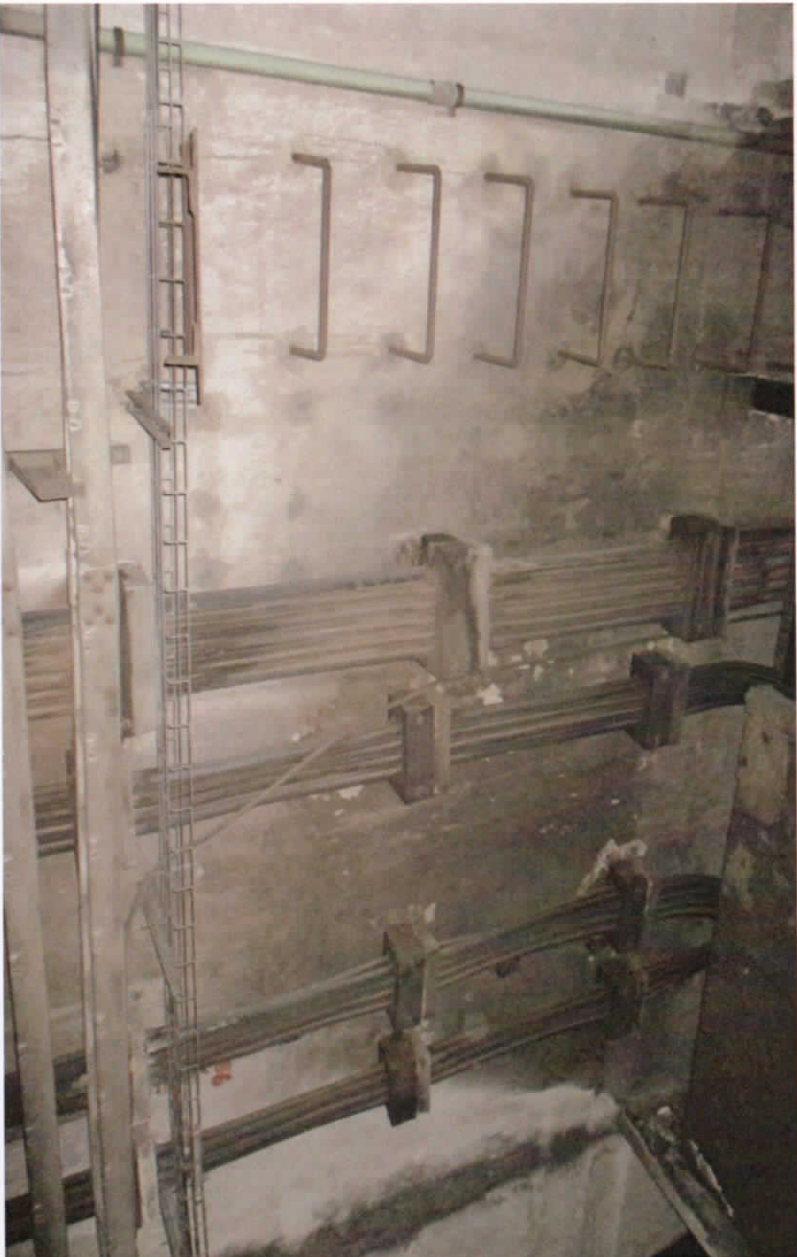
Se ve la pared por donde bajan los cables de tracción hacia vía 2. Se observa otra escalera tipo marina de acceso al nicho de tracción.
